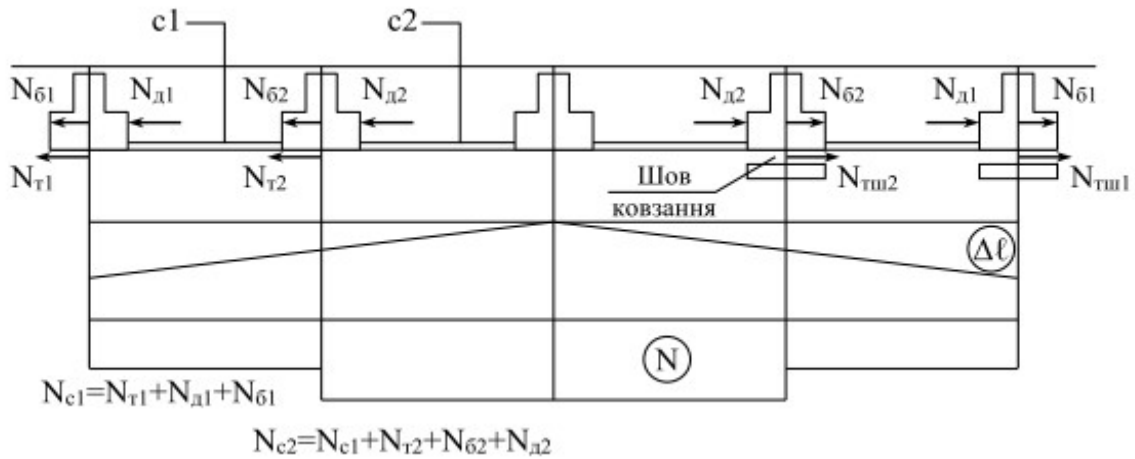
Принципова схема навантажень на фундаменти від горизонтальних деформацій земної поверхні ϵ : AI - графік горизонтальних переміщень основи; N - графік поздовжніх сил в фундаментних зв'язках-розпірках; $c1, c2$ - фундаментні зв'язки-розпірки; M_1, M_2, M_3 - відповідно зрушуючі сили по підшві, нормальні тиски на лобові поверхні і зрушуючі сили по бічним поверхням фундаменту; M_4 - поздовжні сили в фундаментних зв'язках-розпірках
